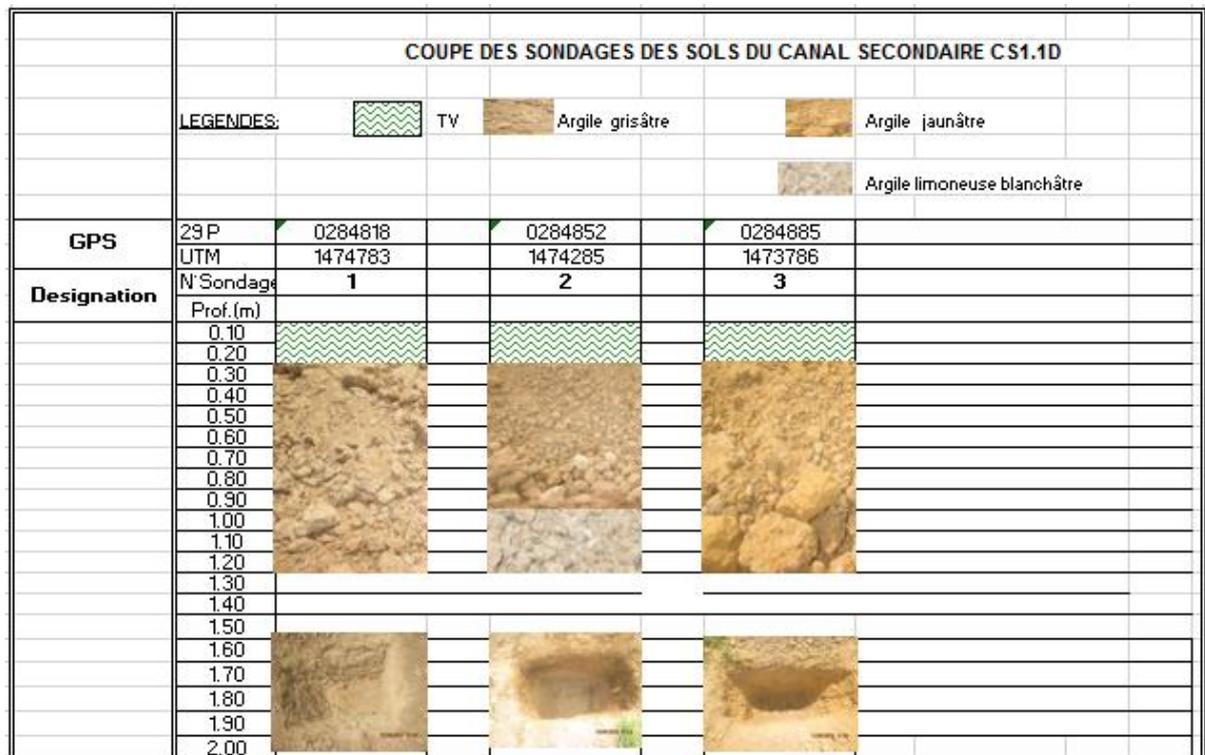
Coupe des sondages du canal secondaire CS1.1D
